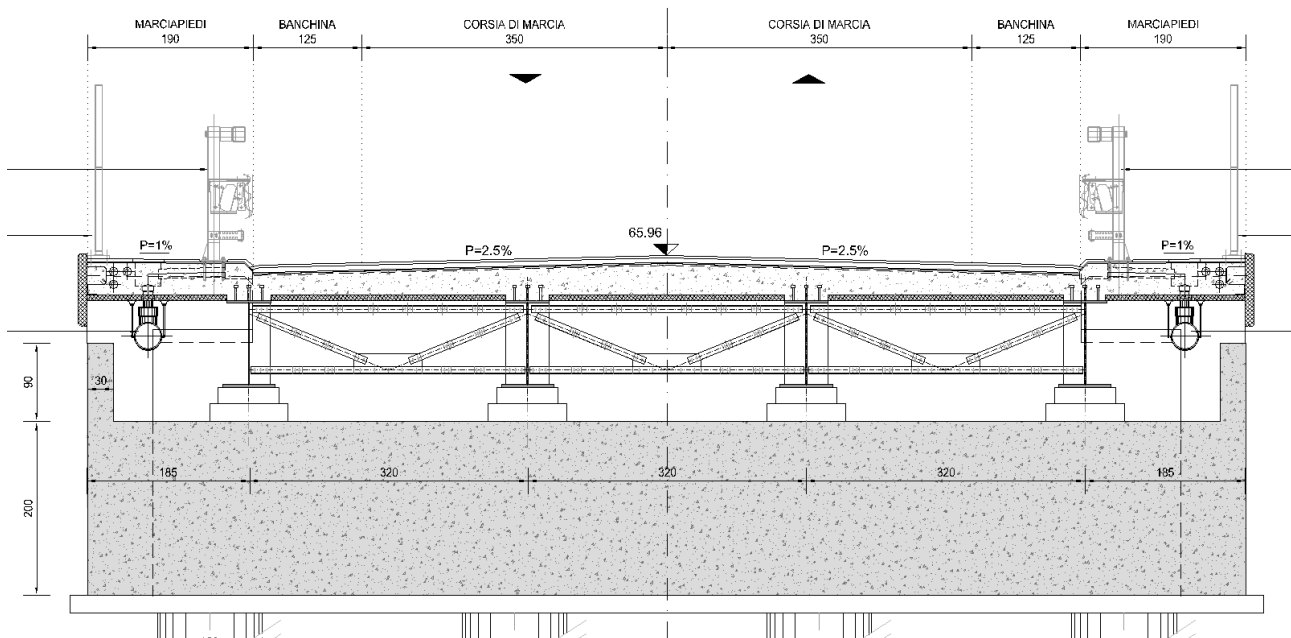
SEZIONE TIPICA IMPALCATO (SU SPALLA)
